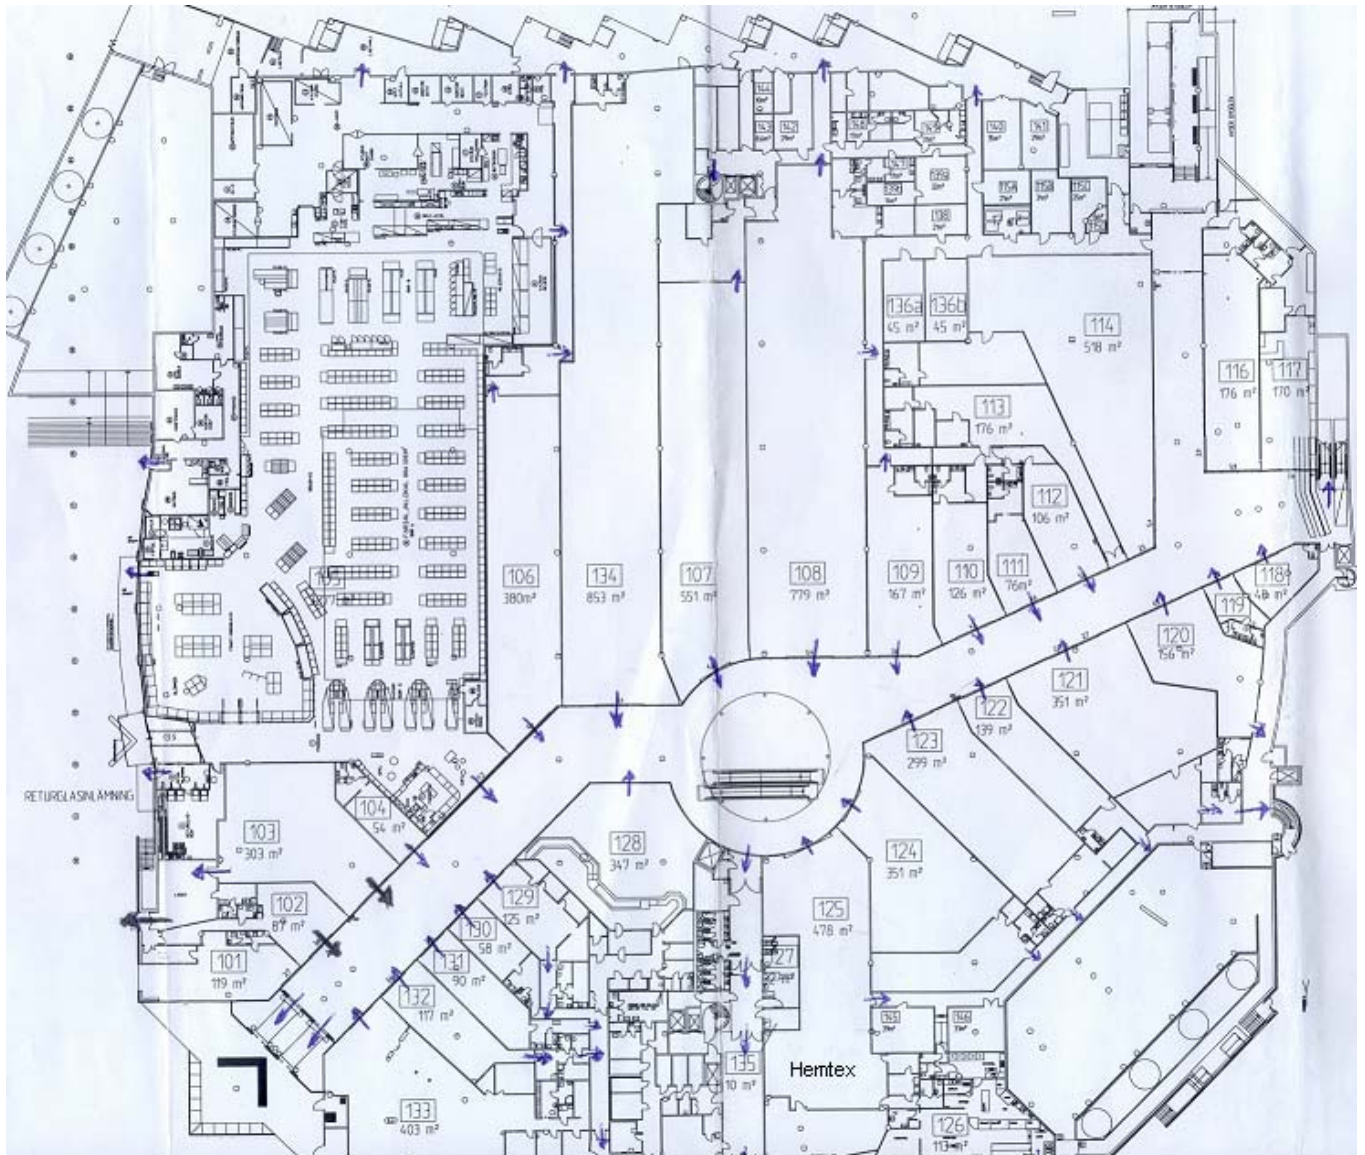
översikt över plan 2 (Steen & Strøm Sverige AB, 2006)
